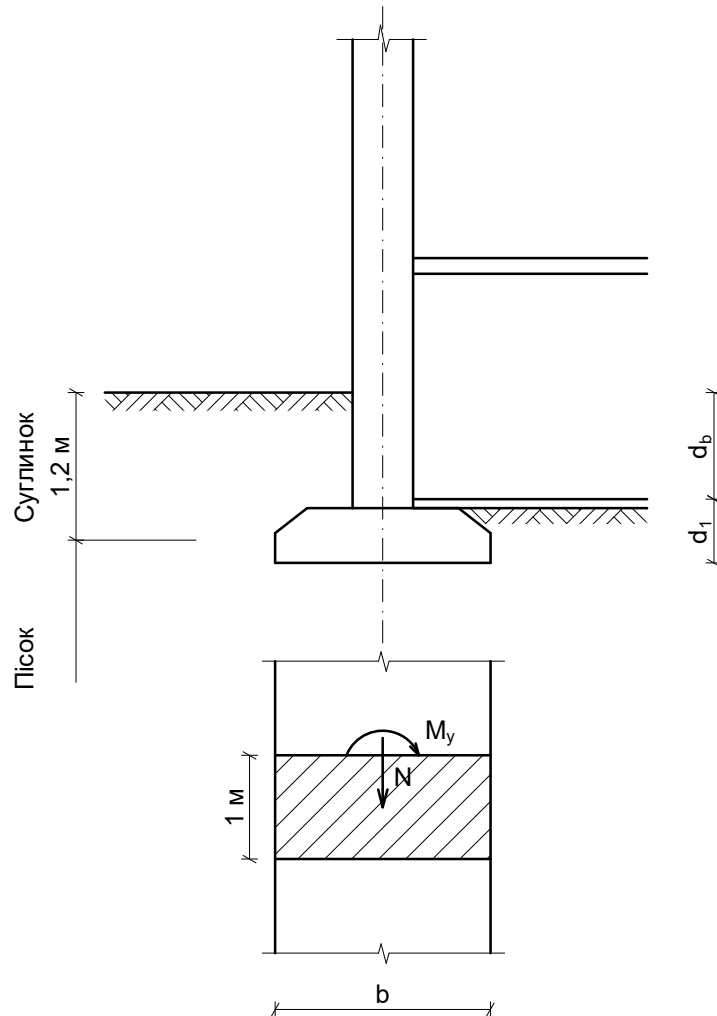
Схема розміщення стрічкового фундаменту у ґрунті
